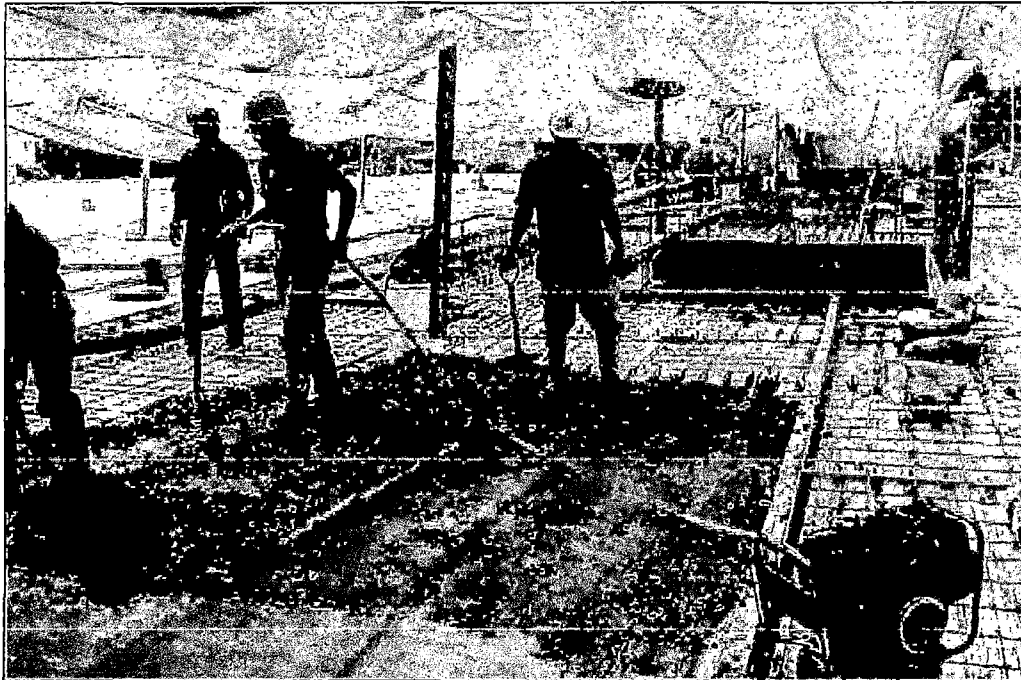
Vaciado de concreto sobre la losa colaborante
